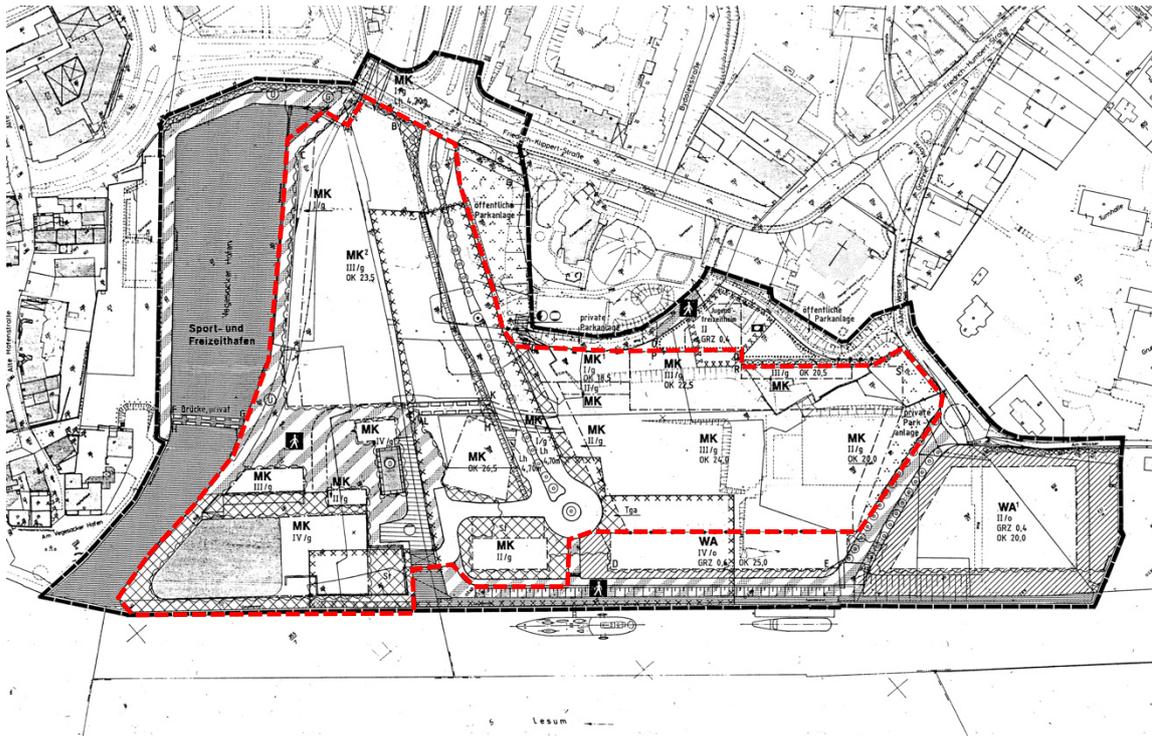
Ursprungsbebauungsplan Nr. 1218 – Plangebiet der 1. Änderung rot gestrichelte Linie (Quelle: Bauamt Bremen Nord, bearbeitet durch A+S)
